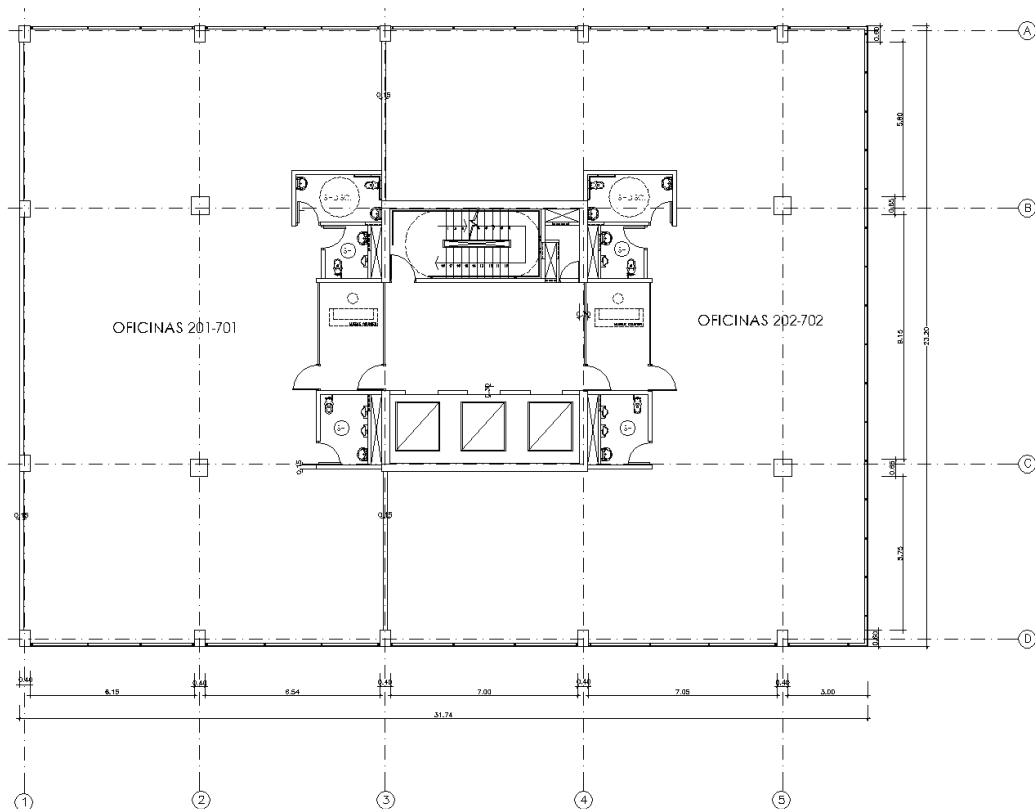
Planta de arquitectura del piso típico (segundo al séptimo piso).
